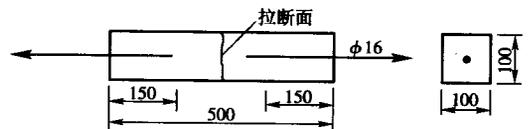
混凝土轴心抗拉强度试验(尺寸单位:mm)
